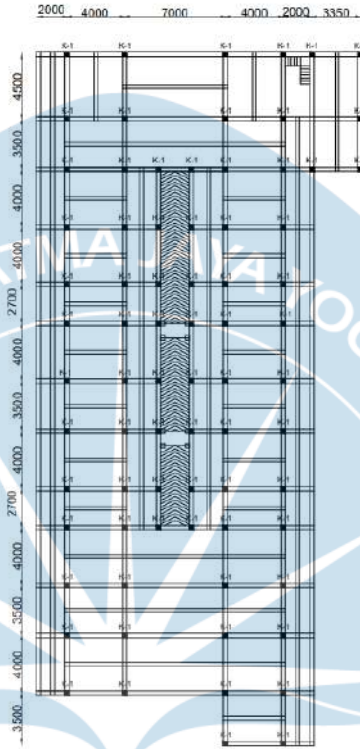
8 Layout Denah Balok Anak Unit 1
